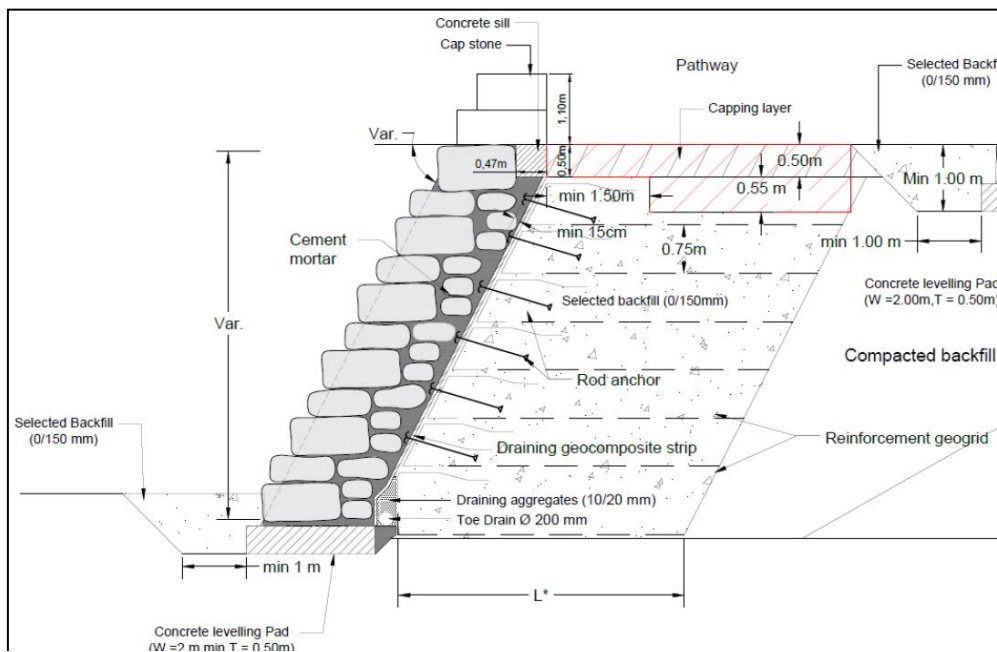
Coupe type d'un mur en sol renforcé (MSE Wall) avec parement minéral
